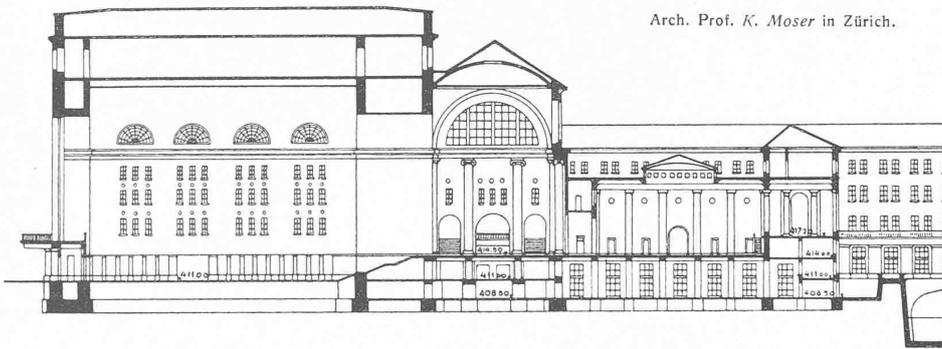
Längsschnitt durch Eingangshalle, Querschnitt durch Haupthalle und Ausgangstunnel (414,00). — 1 : 1000.
